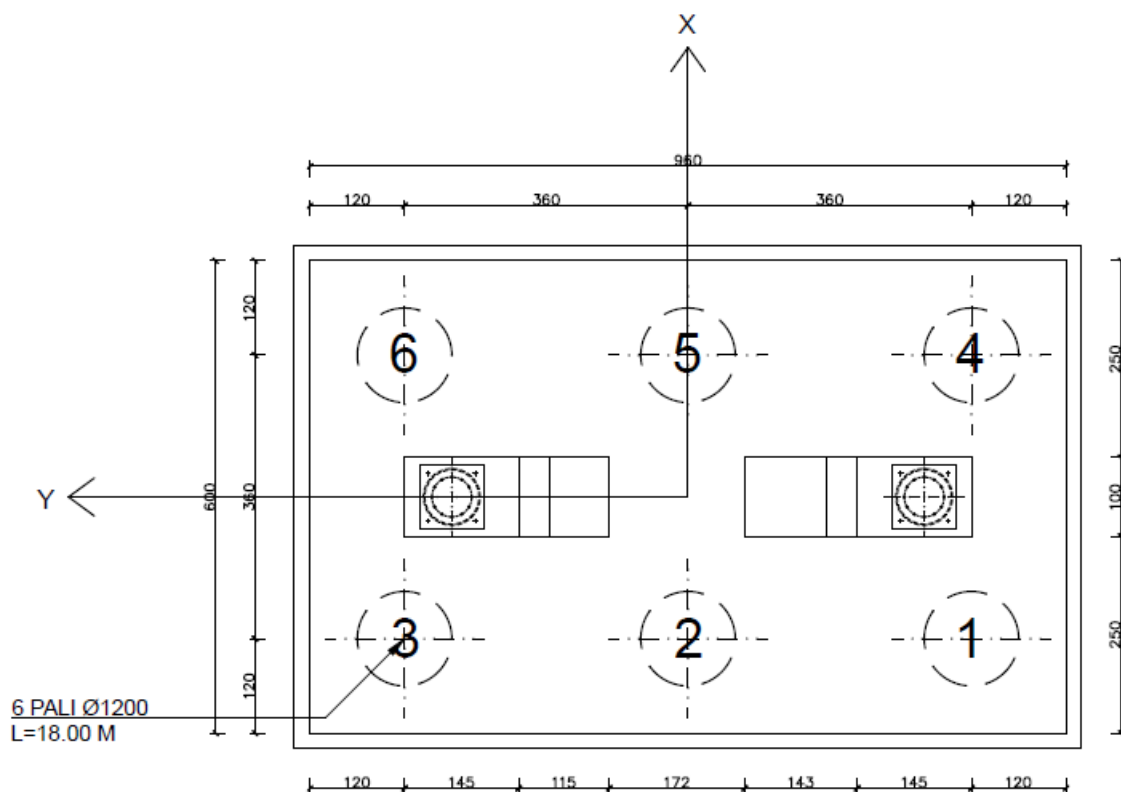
Numerazione pali del plinto di fondazione delle pile
